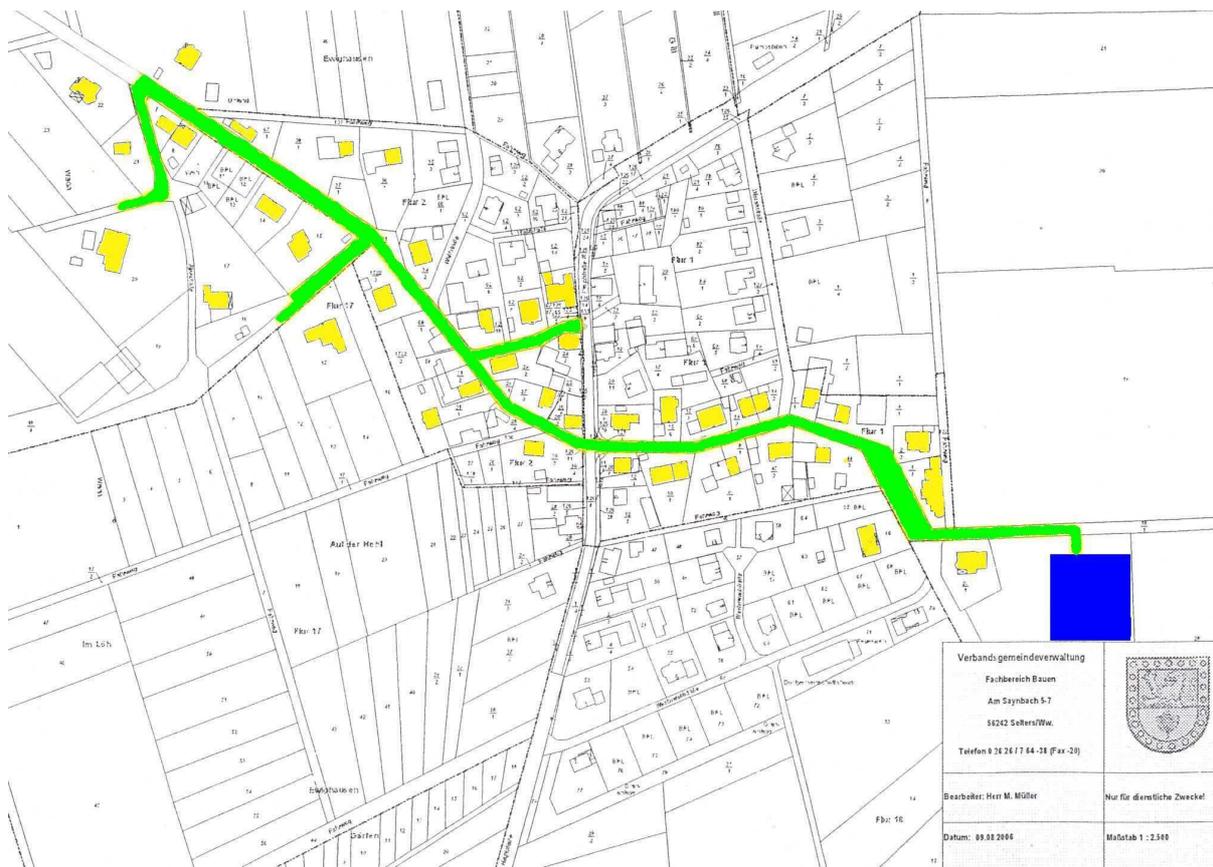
Lageplan Variante eins mit kleinem Nahwärmenetz
